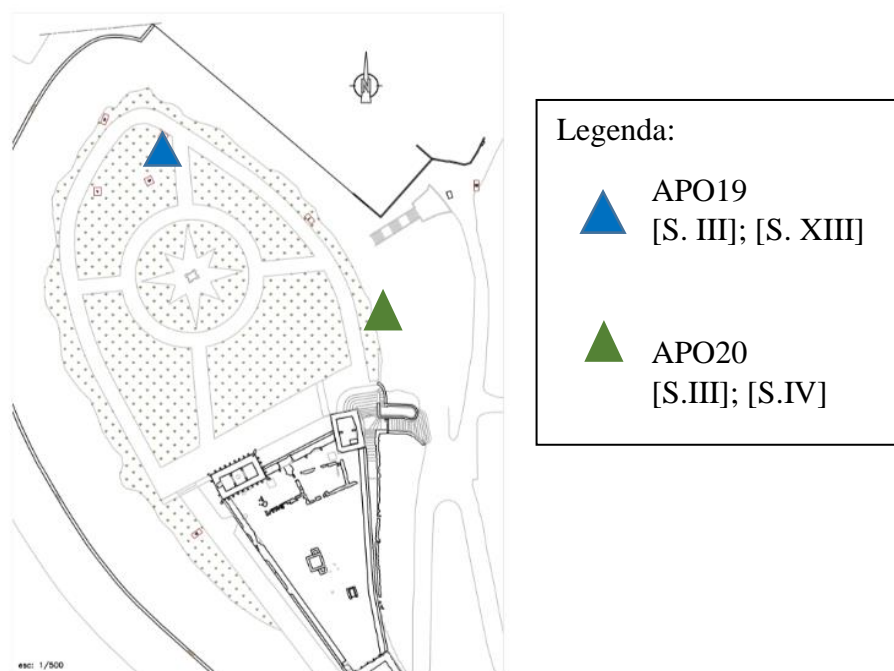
Planta da localização de extração das amostras. Escala: 1/500
